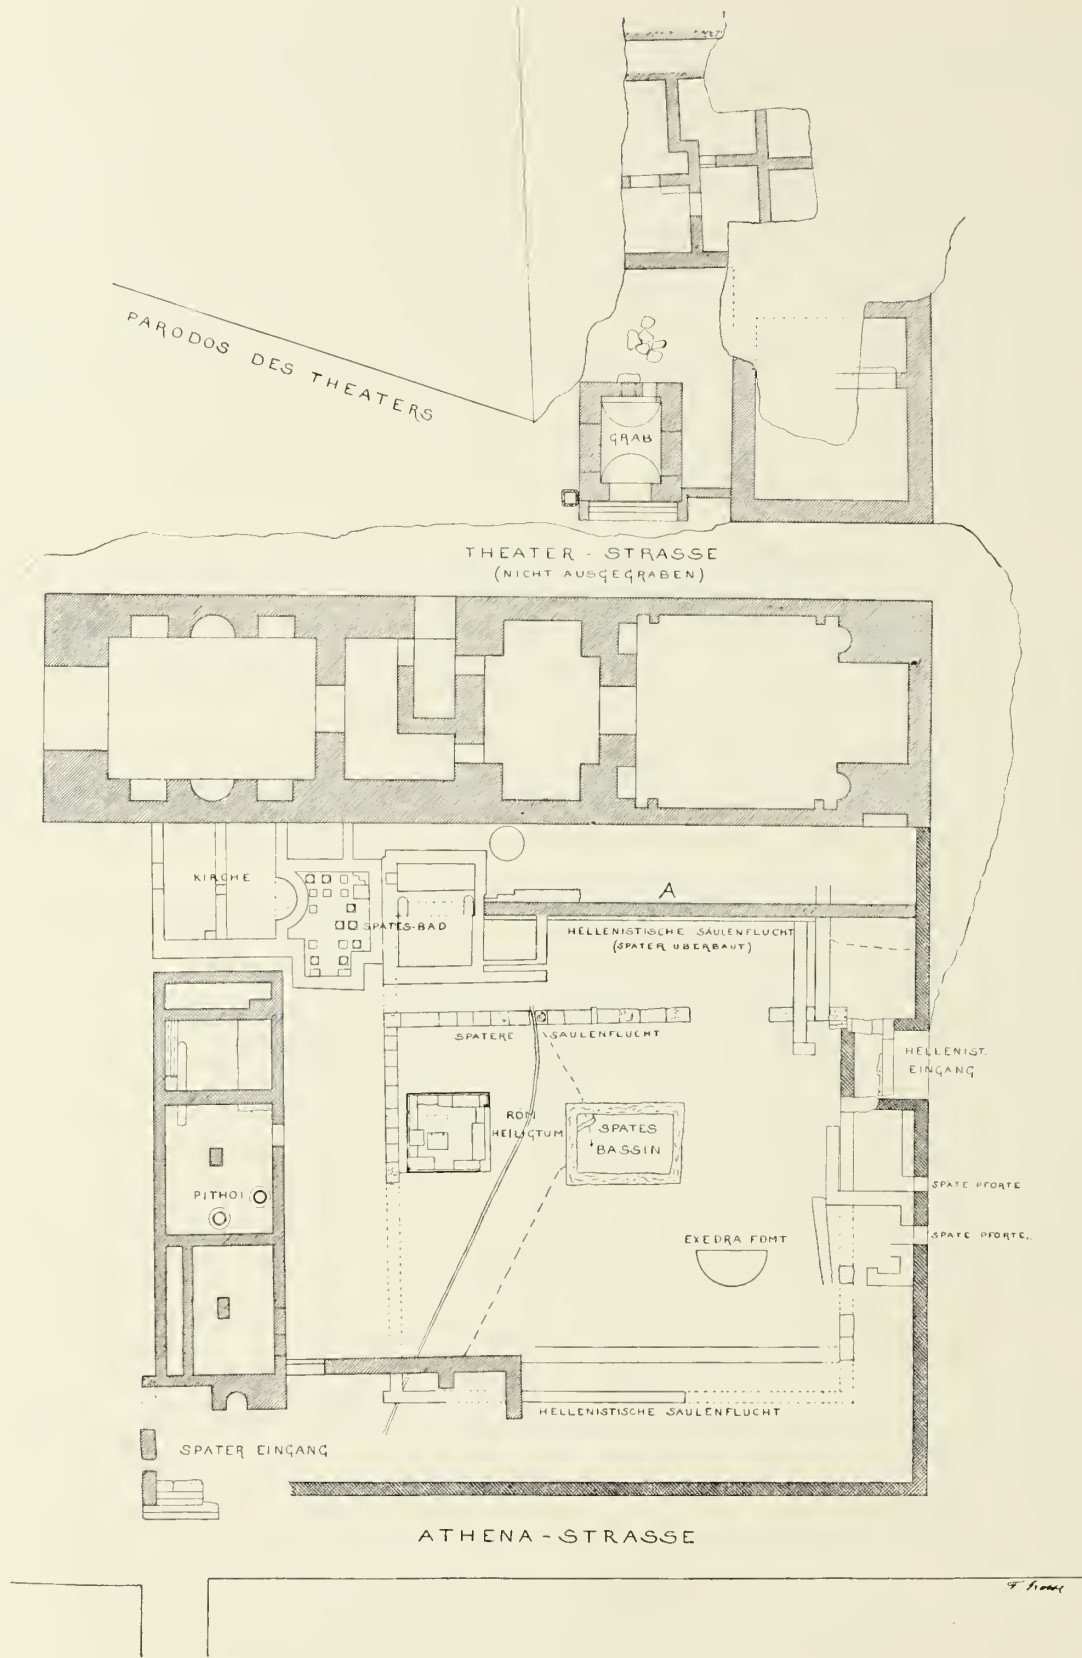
Grundriss des oberen Gymnasion.
